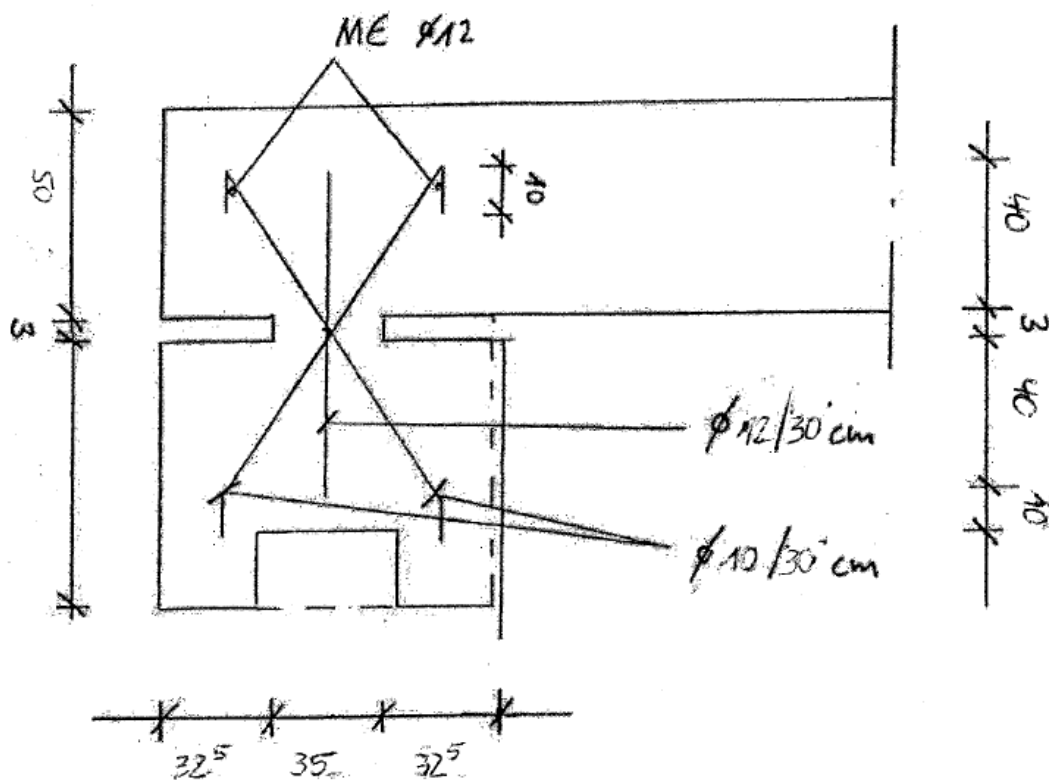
Bewehrungsführung Betongelenk (Auflagerausbildung)
